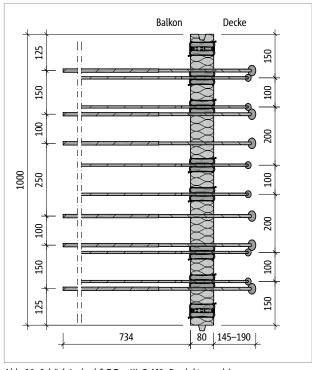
Schöck Isokorb® T Typ KL-O-M2: Produktgrundriss
